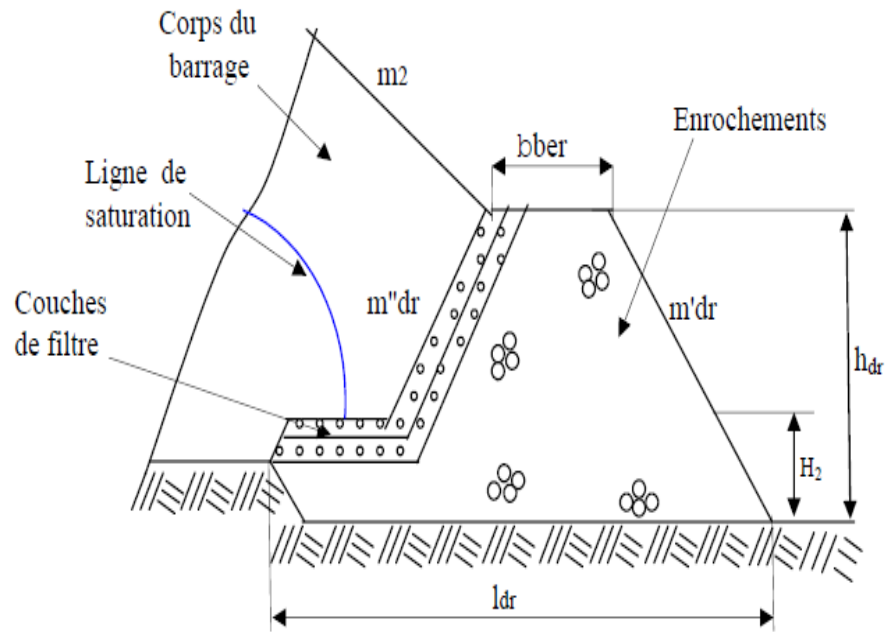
Prisme de drainage avec drain tapis interne sur fondations imperméables
